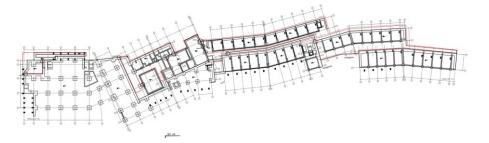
Plano de cimentación Fuente: Elaboración propia.
